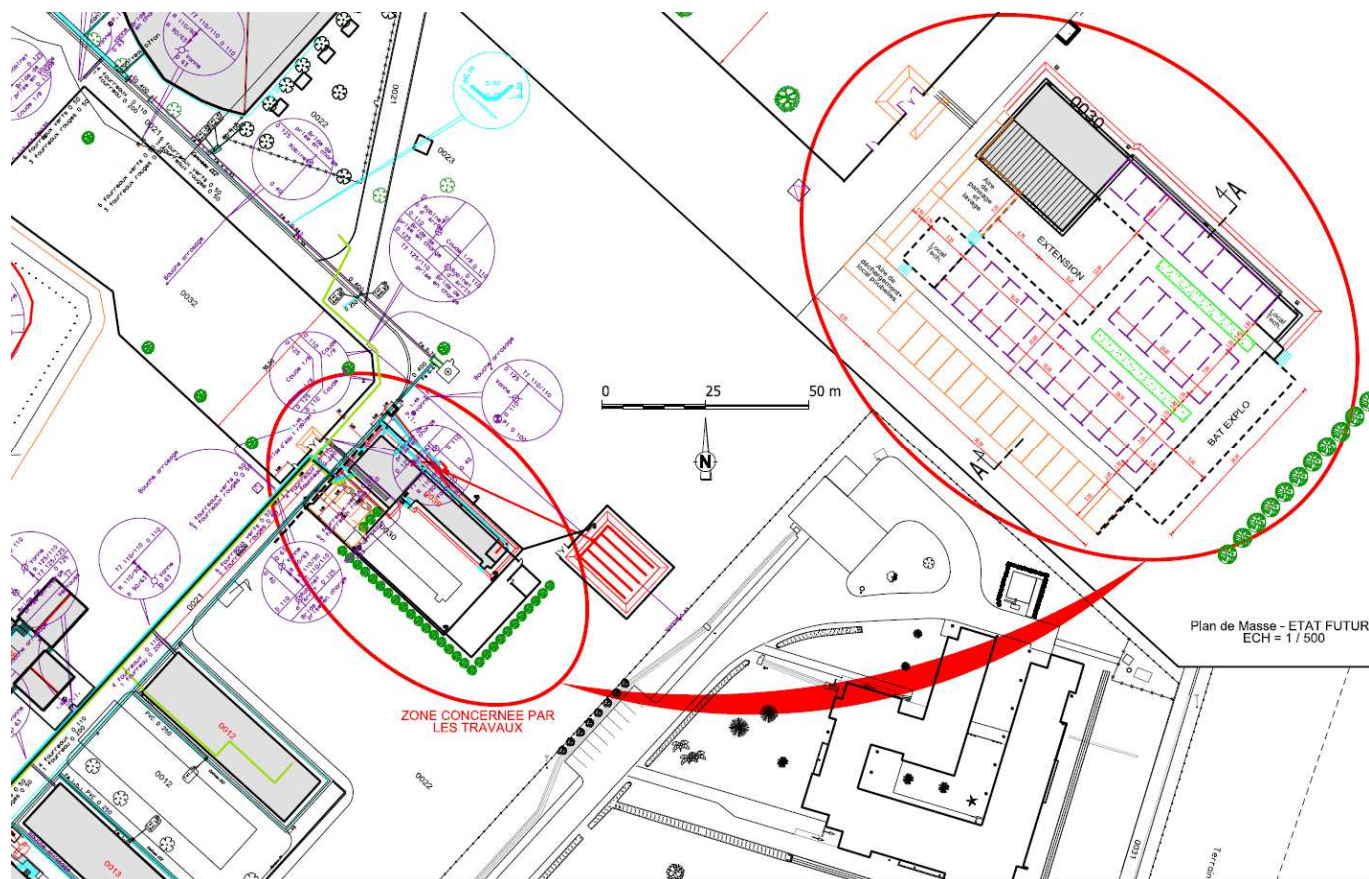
Extrait du plan de masse (doc n°2 §2.1.2)
